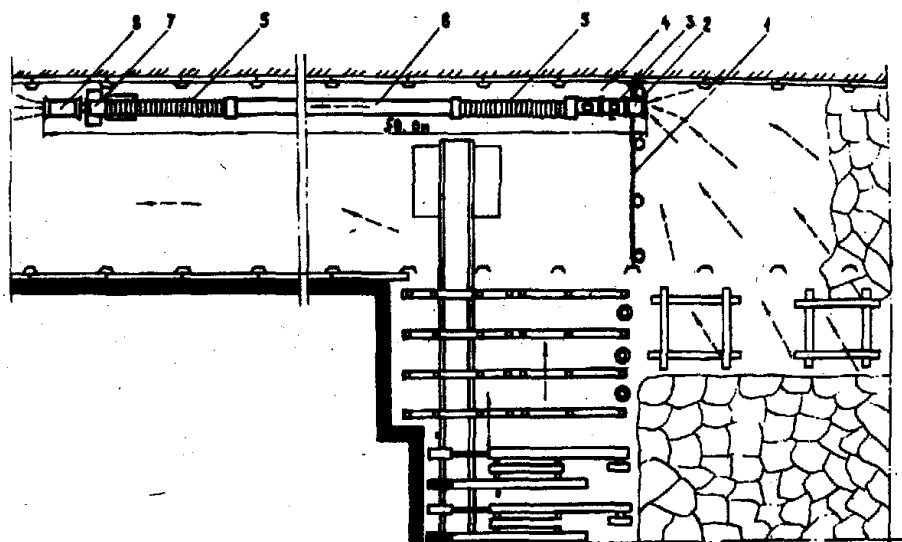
Схема отвода метана с помощью установки УВГ-1: 1 – перемычка; 2 – патрубок; 3 – заслонка; 4 – регулировочное окно; 5 – гибкое соединительное звено; 6 – газотводящий трубопровод; 7 – вентилятор; 8 – смеситель
